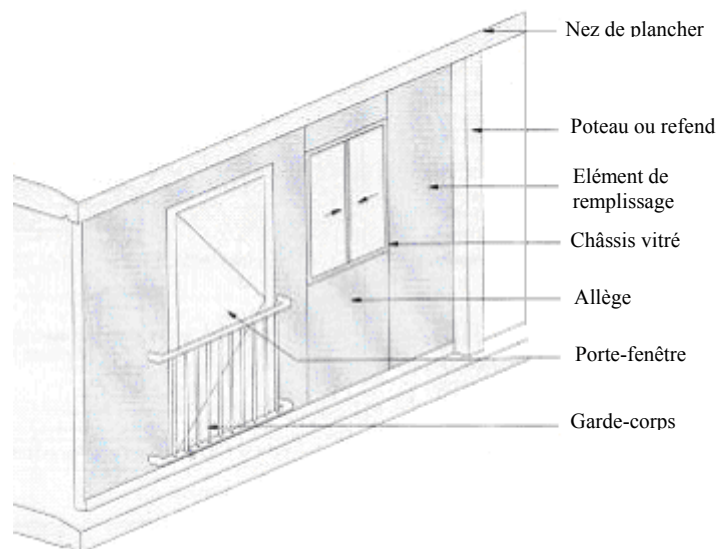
Détail d'une façade panneau [DUTHU, 2004].
